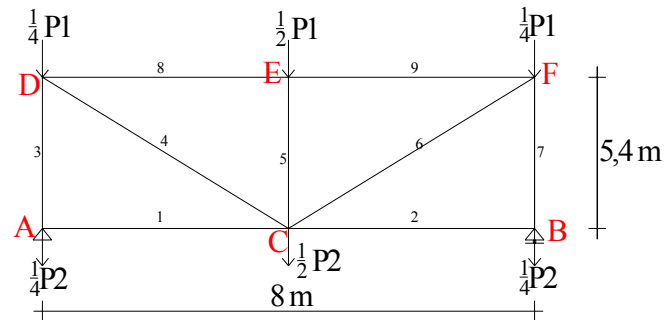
Penyebaran Beban Angin Pada Ikatan Angin Atas
